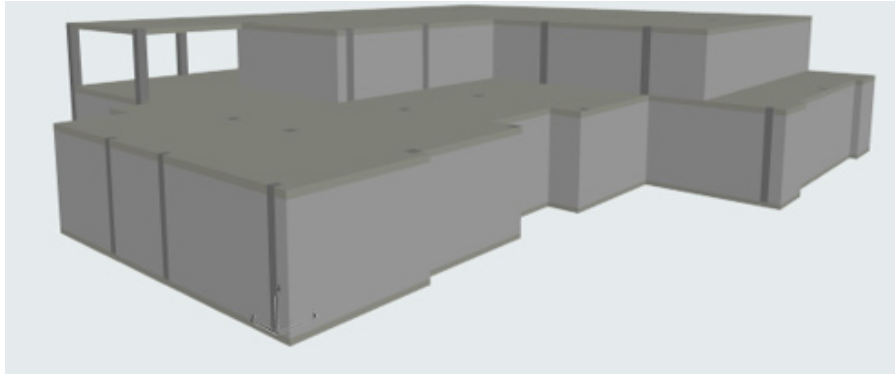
Vista 3D de paredes exteriores, columnas y forjados. Elaboración: Del autor.
